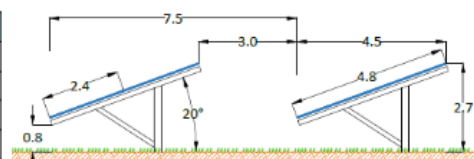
Détail des panneaux et structure PV extrait du permis de construire — CLT architectes – 12/10/2021
